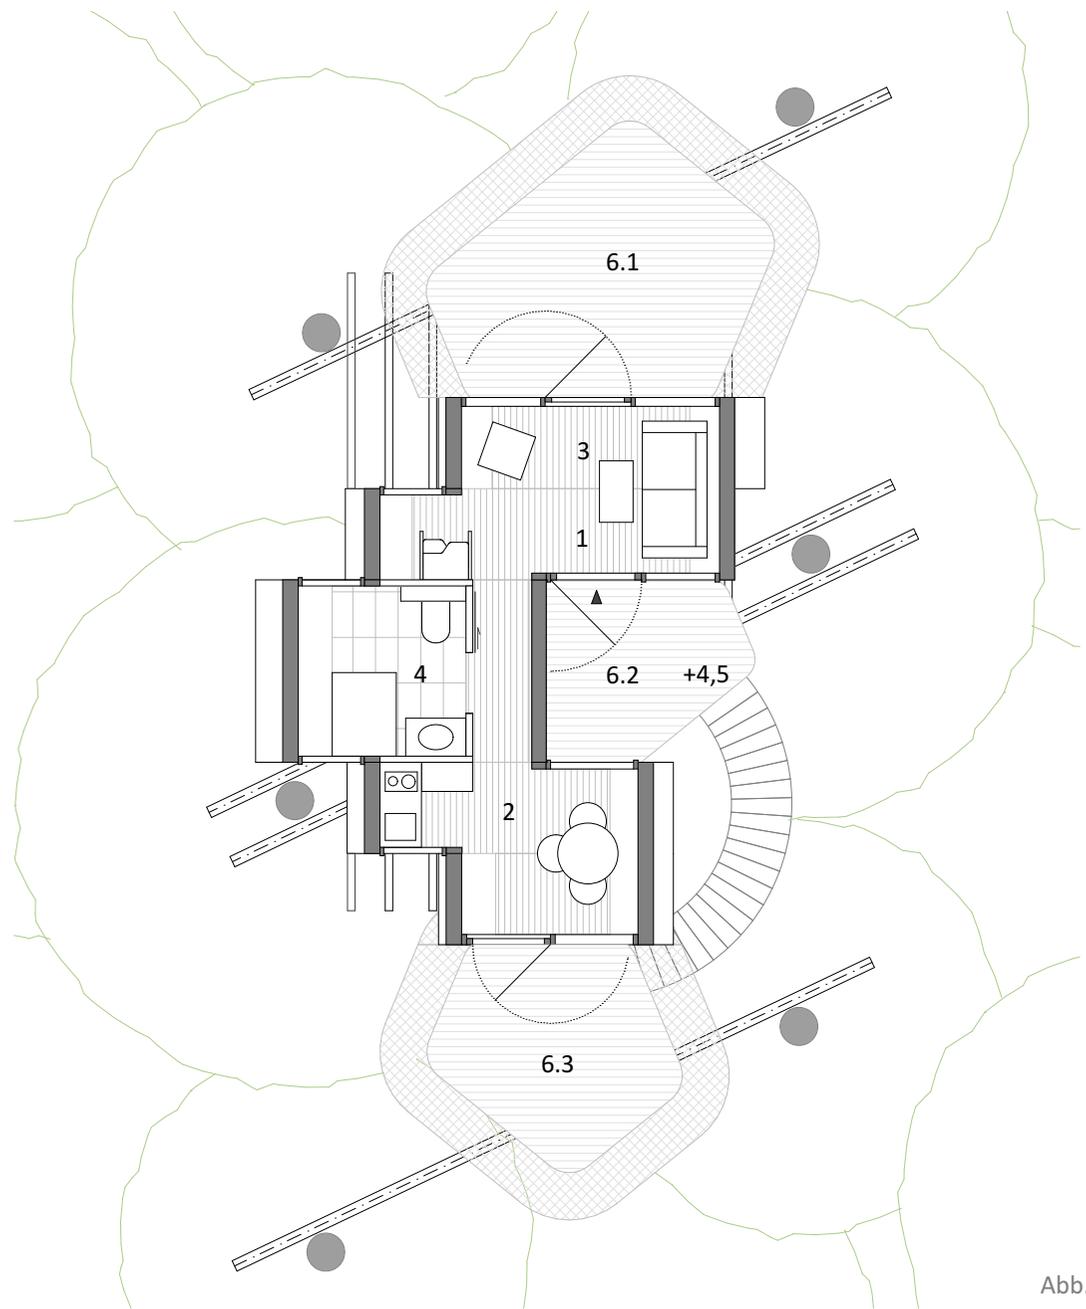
Grundriss_Untere Etage_ M 1:100
